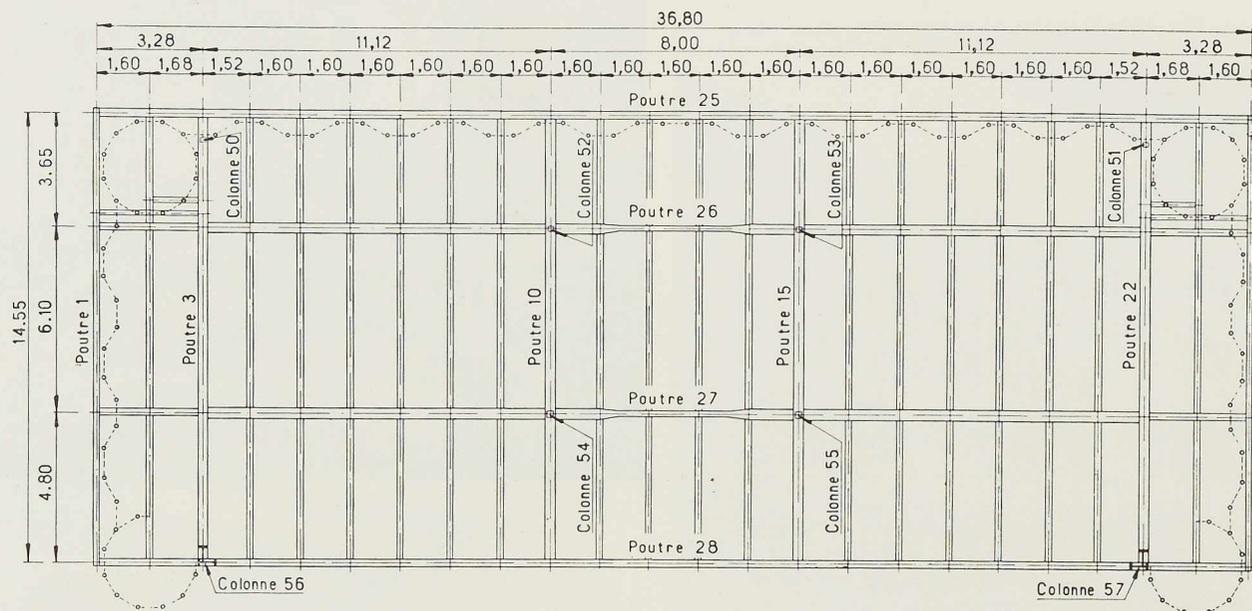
Vue en plan de l'ossature métallique soudée du pavillon.
